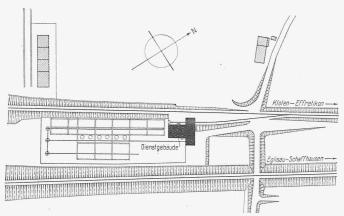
Lageplan des Freilult-Unterwerkes Seebach. - Masstab 1:3000.
